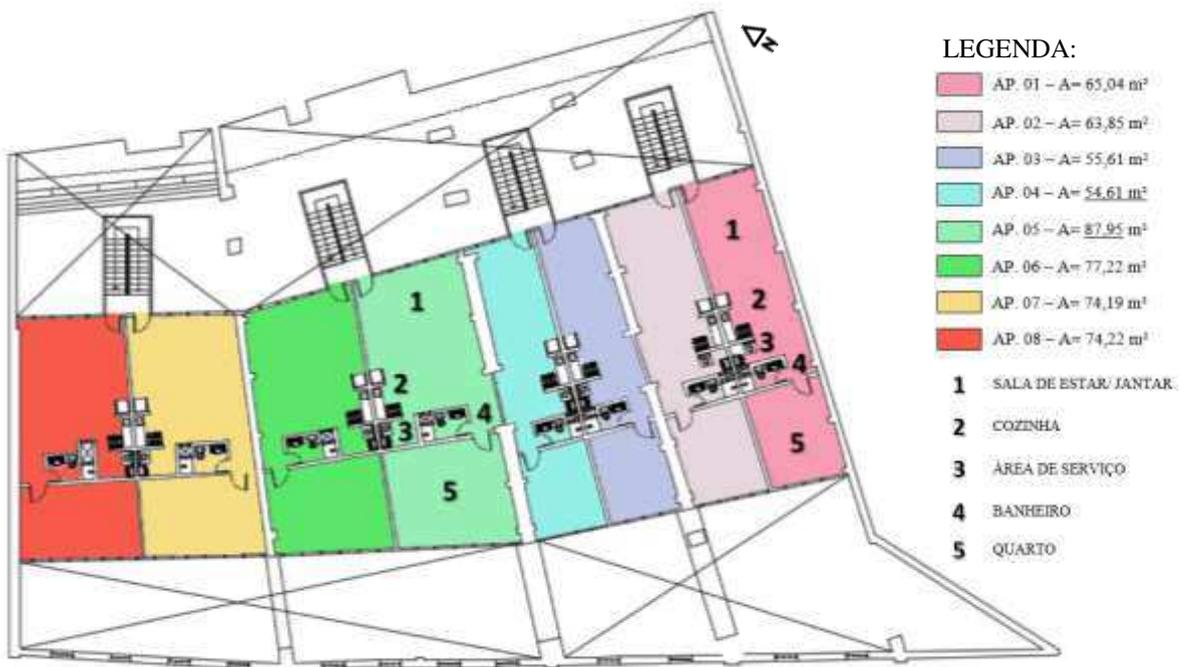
Planta Baixa do pavimento superior do prédio Morada das Artes.
